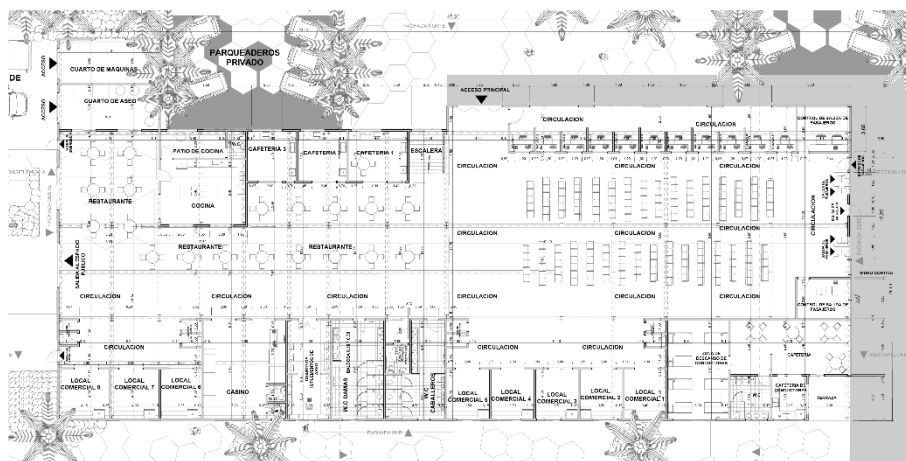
Plano de primer piso, Fuente: elaboración propia.
